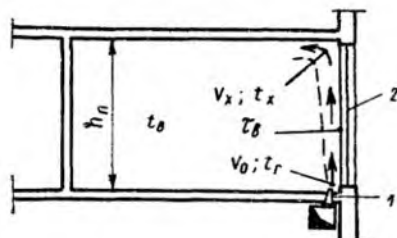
Центральное воздушное отопление помещения с подачей нагретого воздуха через напольный щелевой воздухоораспределитель 1 вдоль наружного ограждения 2
